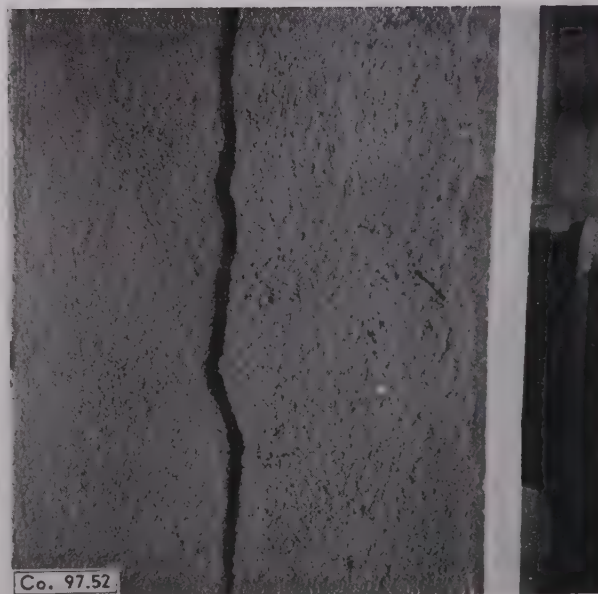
Conduit revêtu d'un enduit ciment [6].
